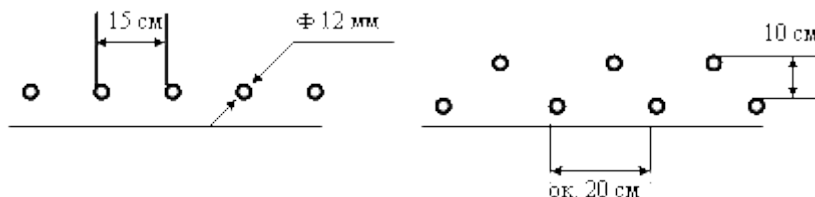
Размещение отверстий для инъекций в стену при выполнении горизонтальной гидроизоляции.
